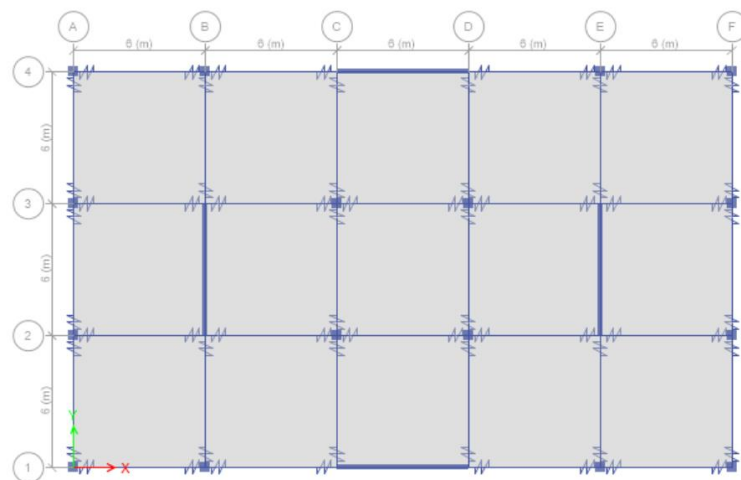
Distribución de rótulas perfectas en planta estructura auxiliar Edificio Tipo 1
